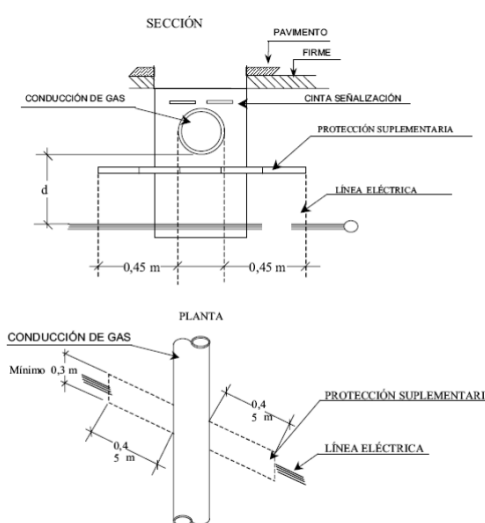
Detalles de cruzamiento y conducciones (ITC-LAT 06)
